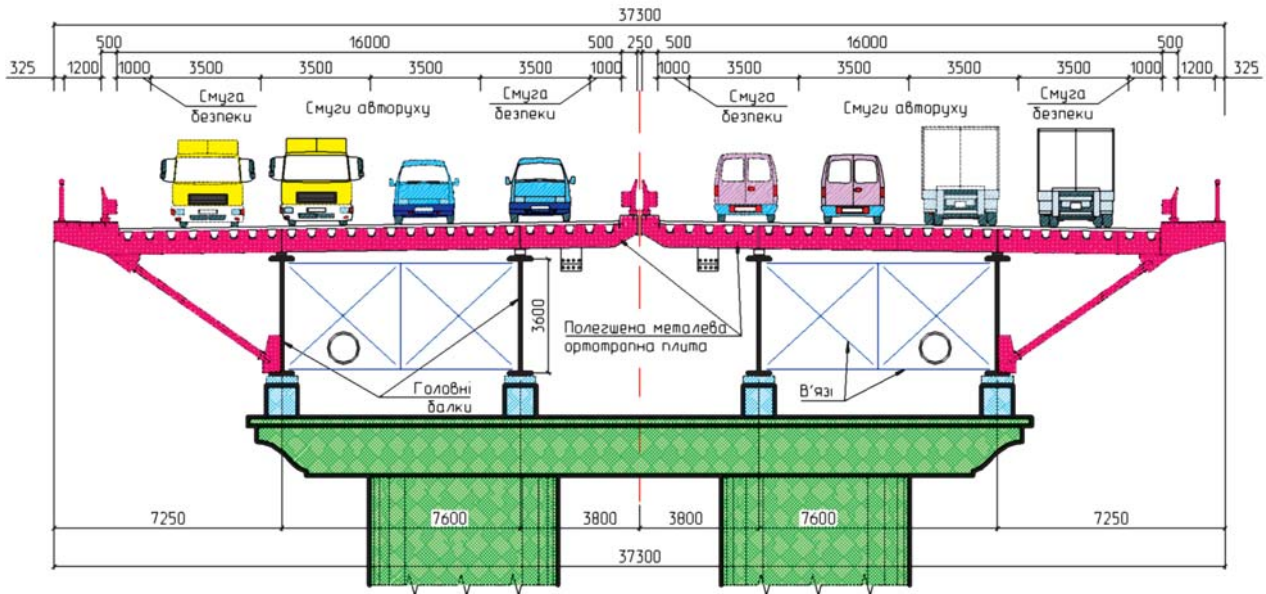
Поперечний переріз моста ім. Є.О. Патона після реконструкції
